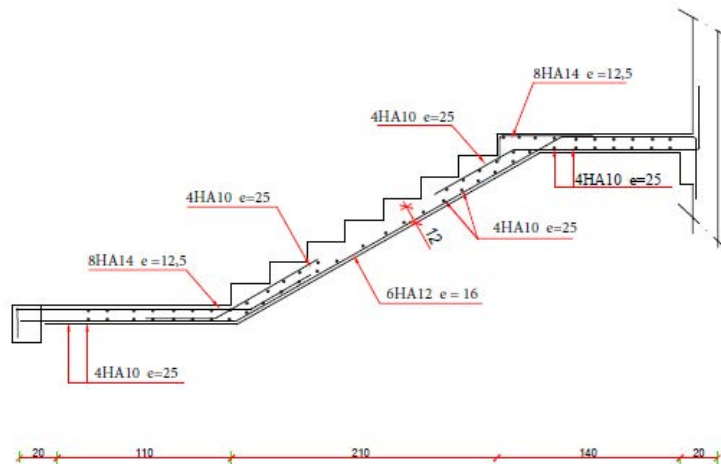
Ferrailage du volée 1 de l'escalier du RDC
